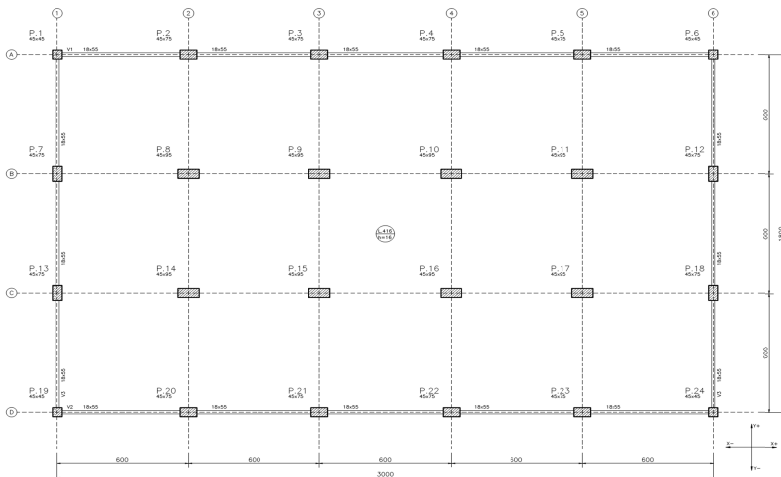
Forma do pavimento tipo da Estrutura 1.
